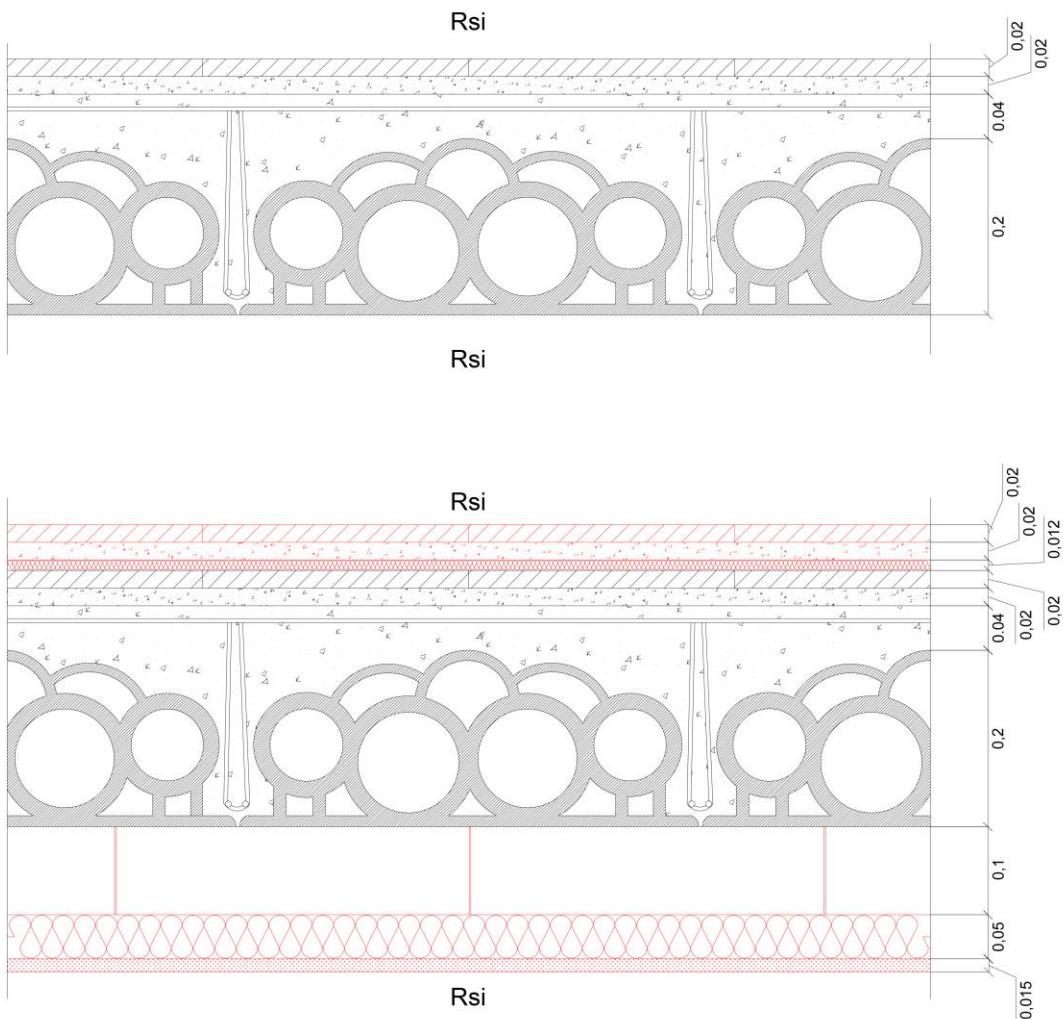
Detalle constructivo de los elementos horizontales de separación entre recintos (forjados) tras el análisis y las propuestas.
